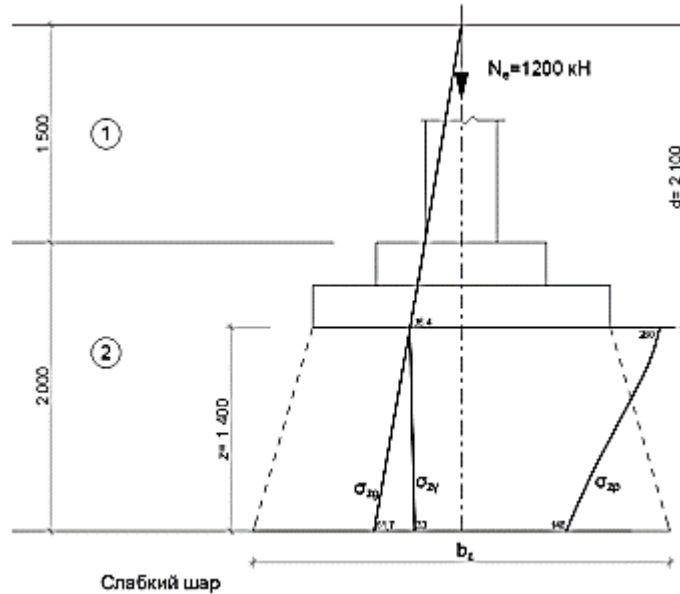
Епюри вертикальних напружень у ґрунті
